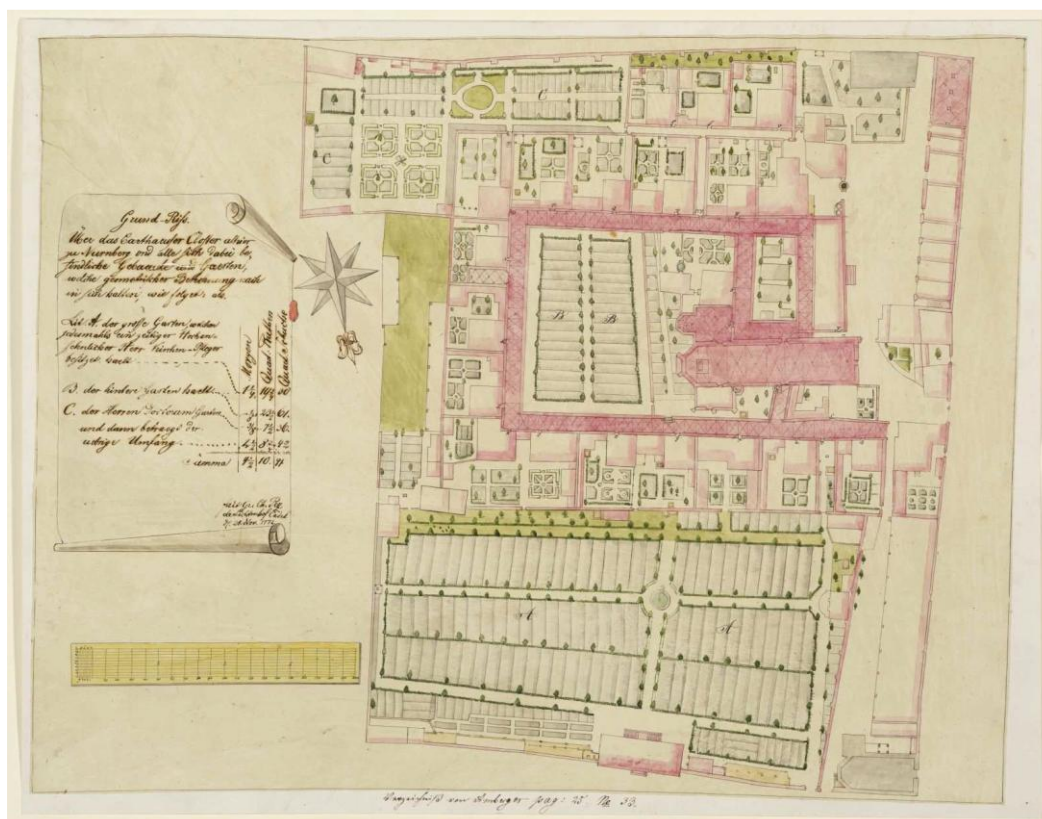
Grundriss des Nürnberger Kartäuserklosters
